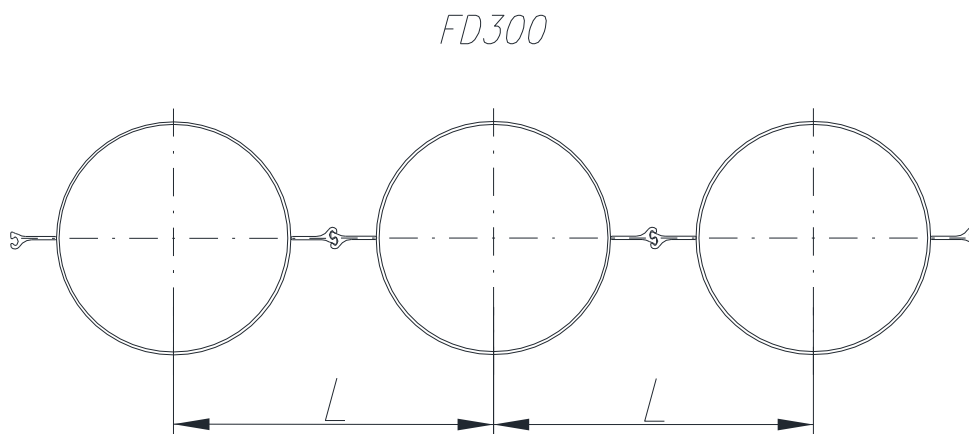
Поперечное сечение стены из шпунта ТСС с замковым профилем FD300
